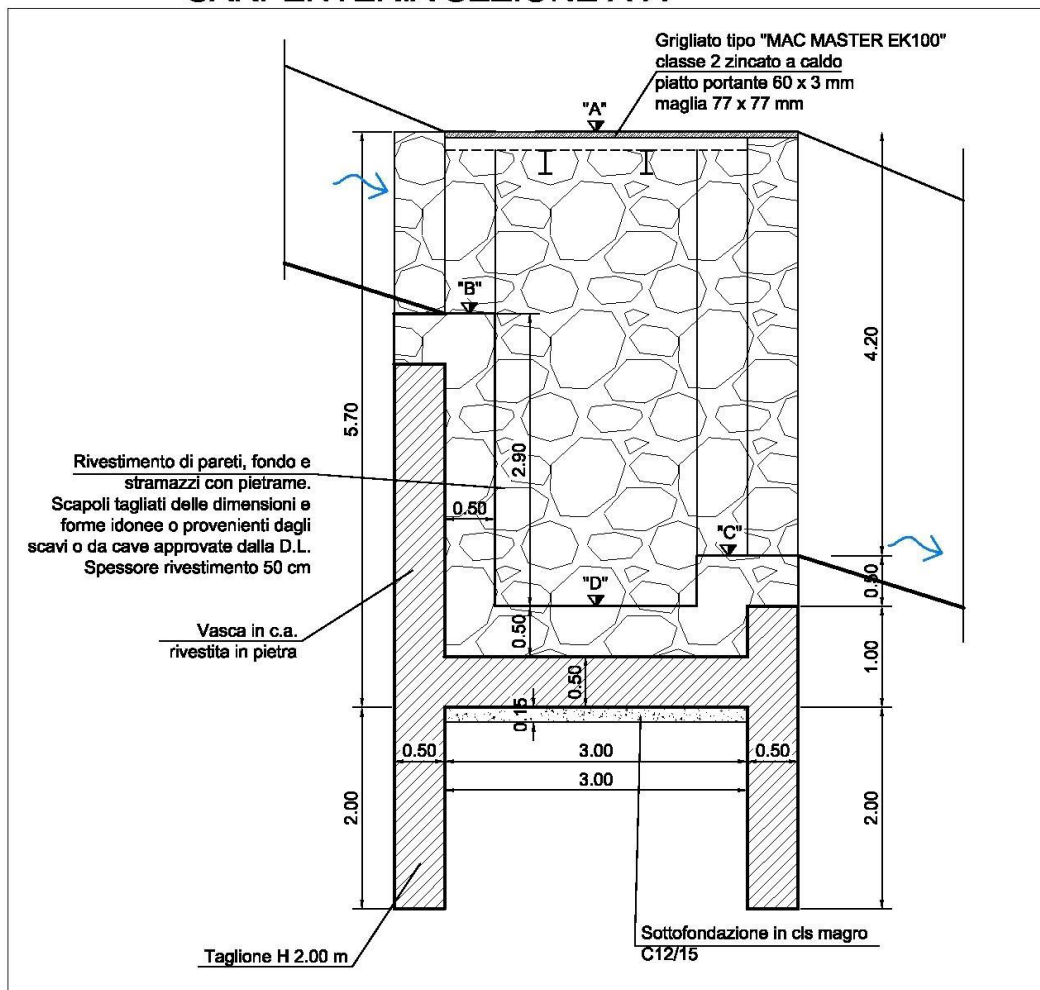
Compluvio centrale – Vasca tipo Vi2-3-4-5-6 - sezione
